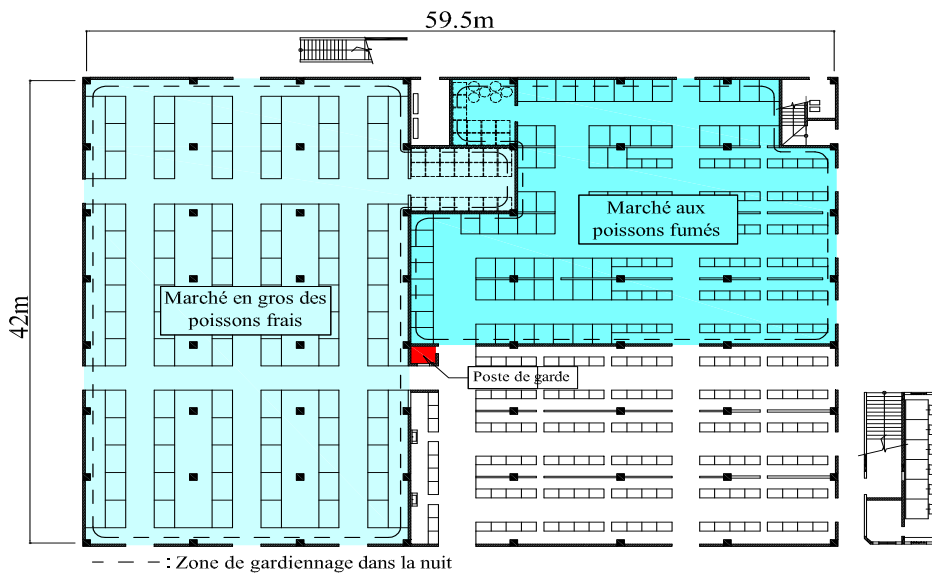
Zone de gardiennage dans la nuit au rez-de-chaussée du bâtiment de marché aux poissons
